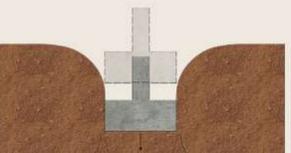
Falla por punzonamiento bajo un elemento de cimentación. Fuente: elaboración propia con base en Ovando (2020).
